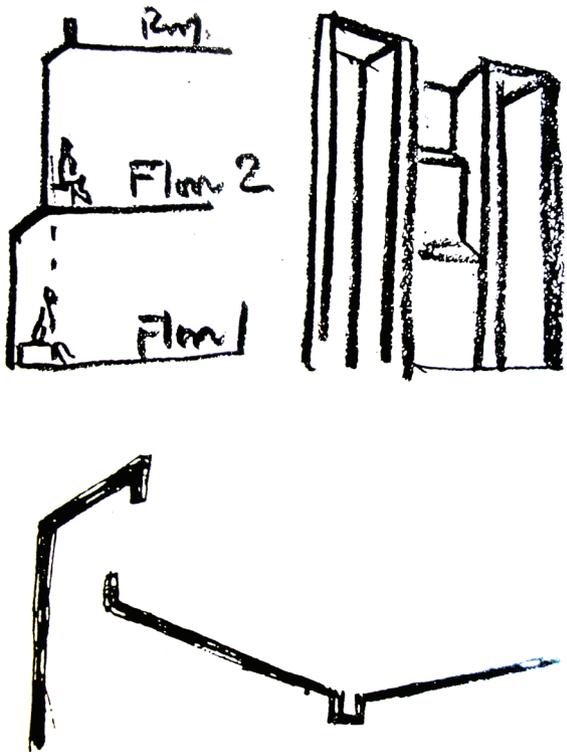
Primeira Igreja Unitária e Escola. Croquis. Elevação, fachada e detalhe.
